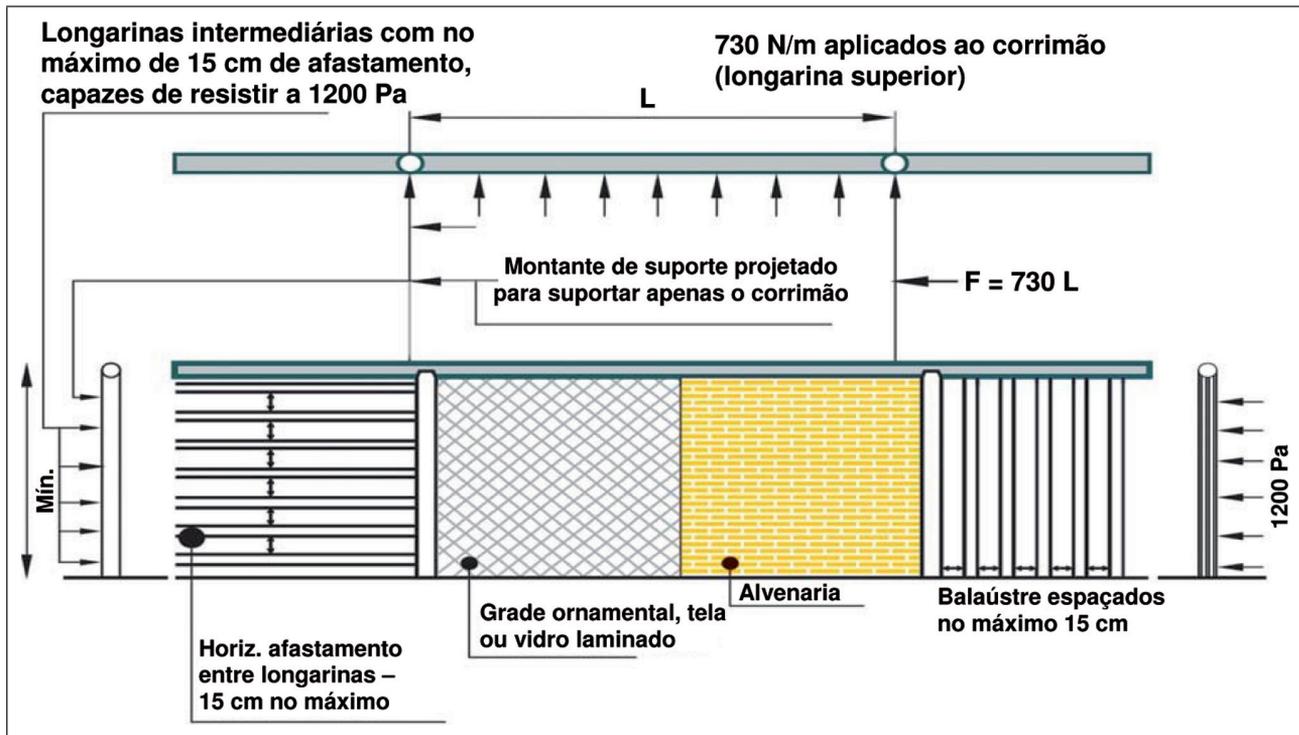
Pormenores construtivos da instalação de guardas e as cargas a que elas devem resistir
